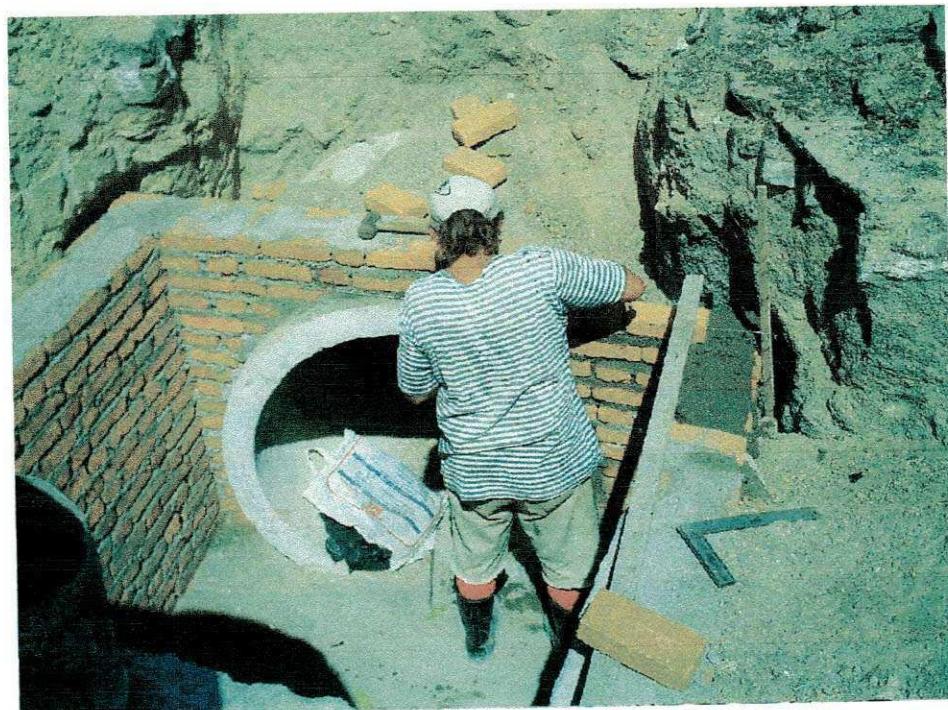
Ligação da rede de drenagem com a caixa de inspeção.
